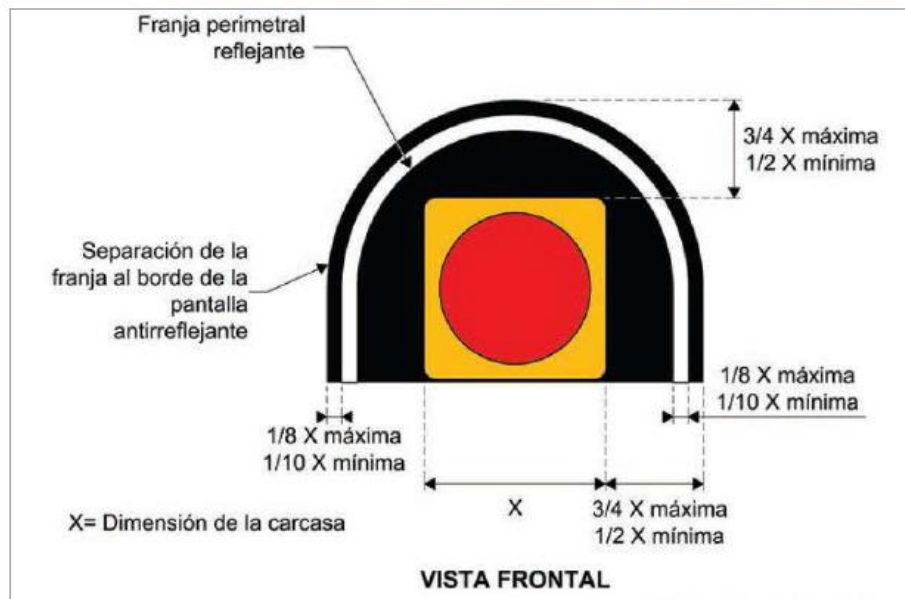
Vista frontal y dimensiones de placa de contraste
